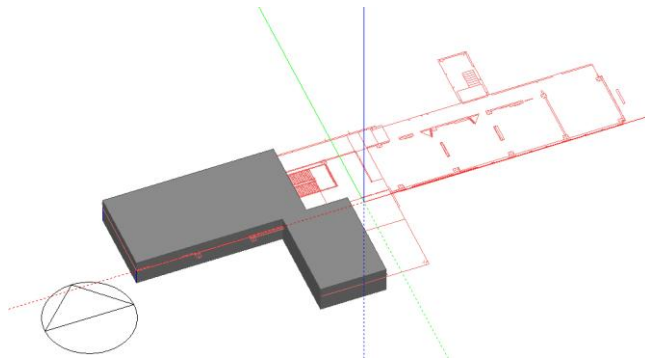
Importación del plano de la entrada del edificio de Ingeniería Eléctrica – *DesignBuilder*.
